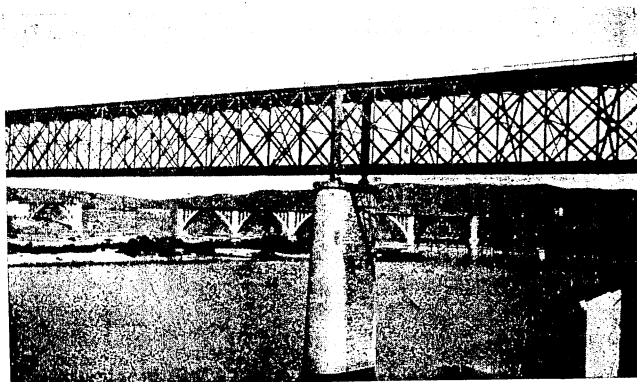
^a Detalle del tramo. (Al fondo, el puente en construcción de la carretera de Salamanca a Cáceres.)
